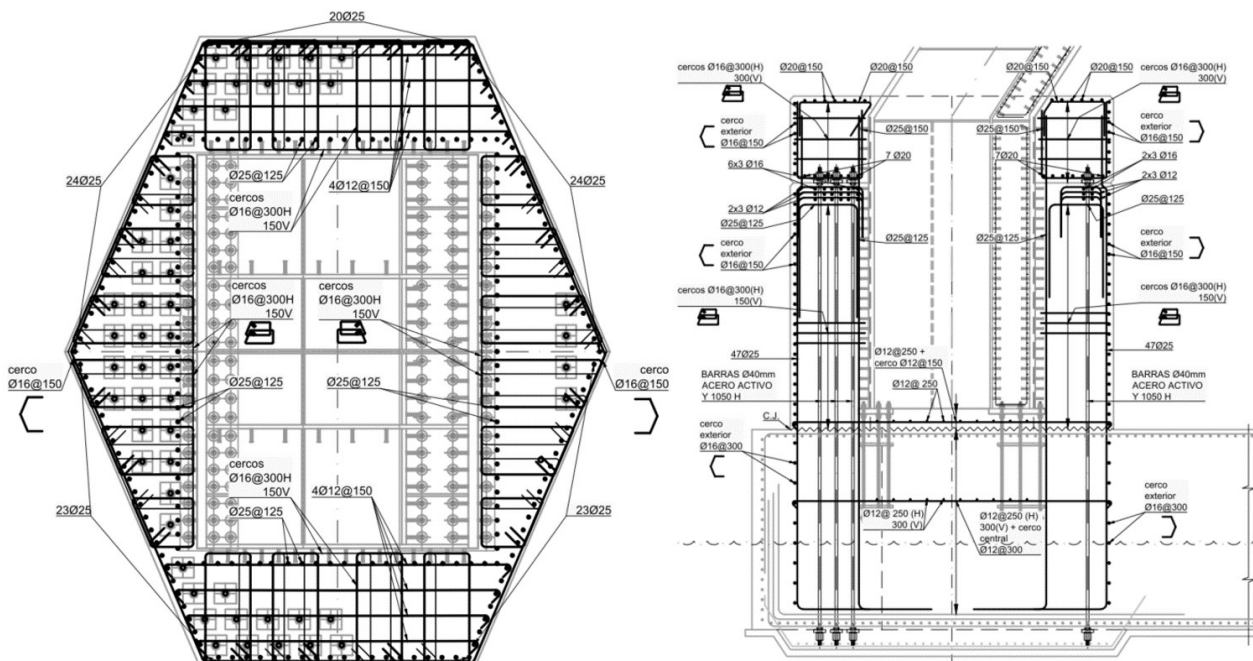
Sección transversal y alzado del pedestal de hormigón.
